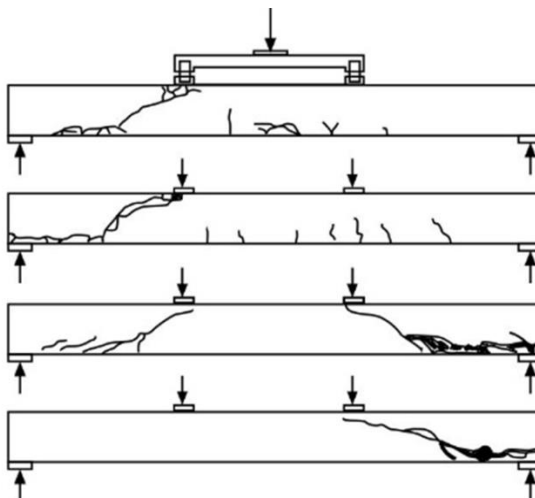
Mapas de fissuras dos ensaios de CHANG e KESLER (1958) para vigas com taxa de armadura longitudinal de $\rho = 1,86\%$ e $2,89\%$.
